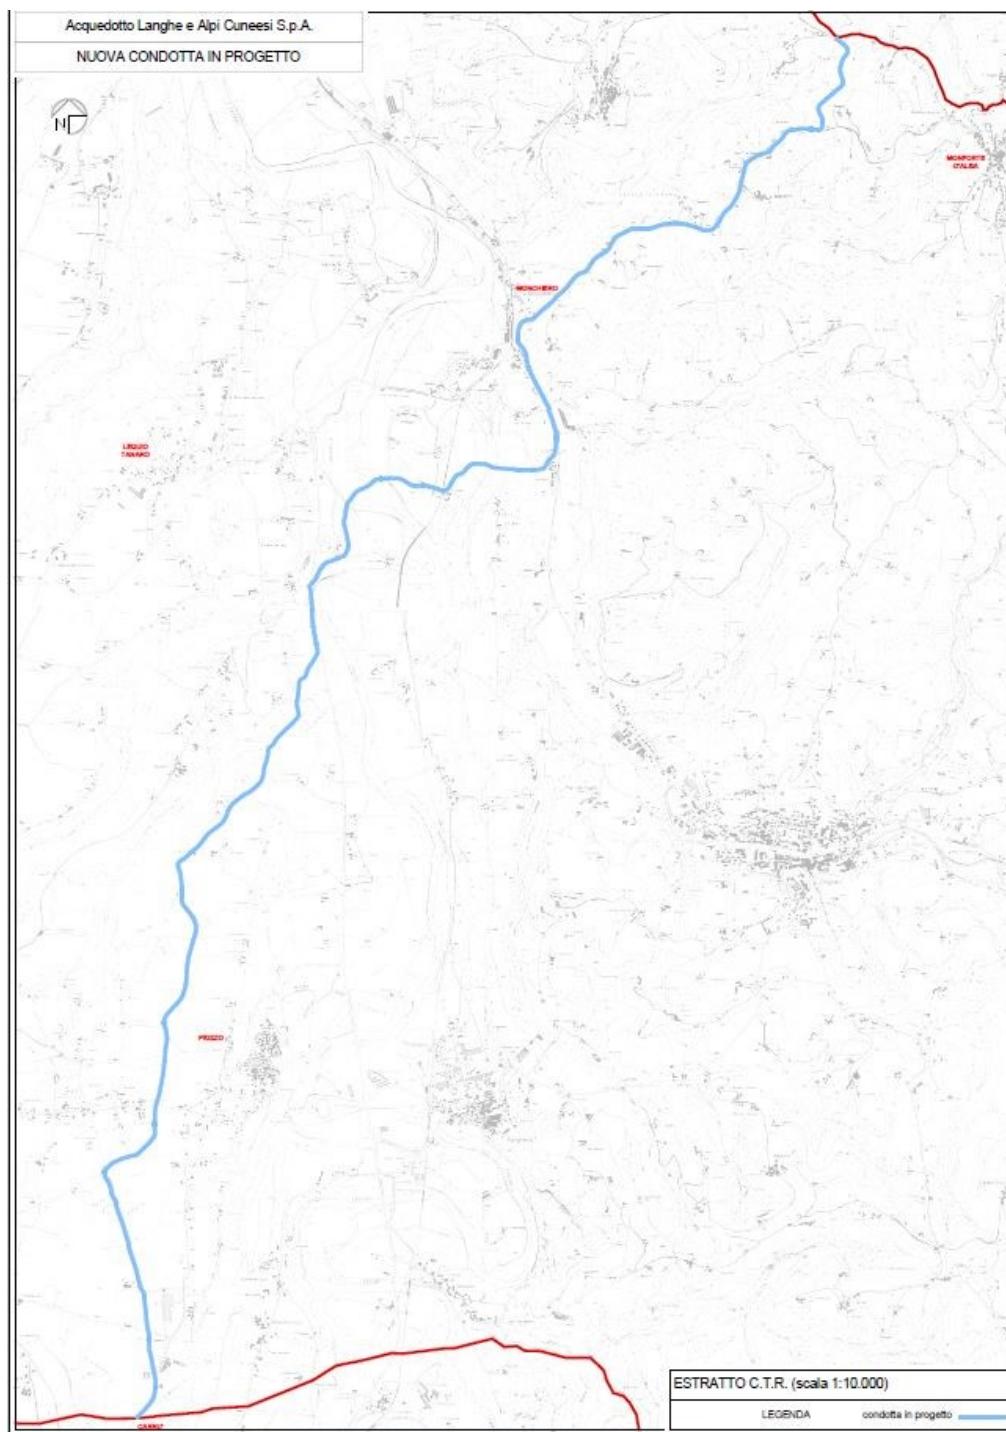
Estratto CTR con individuazione dell'opera in progetto
